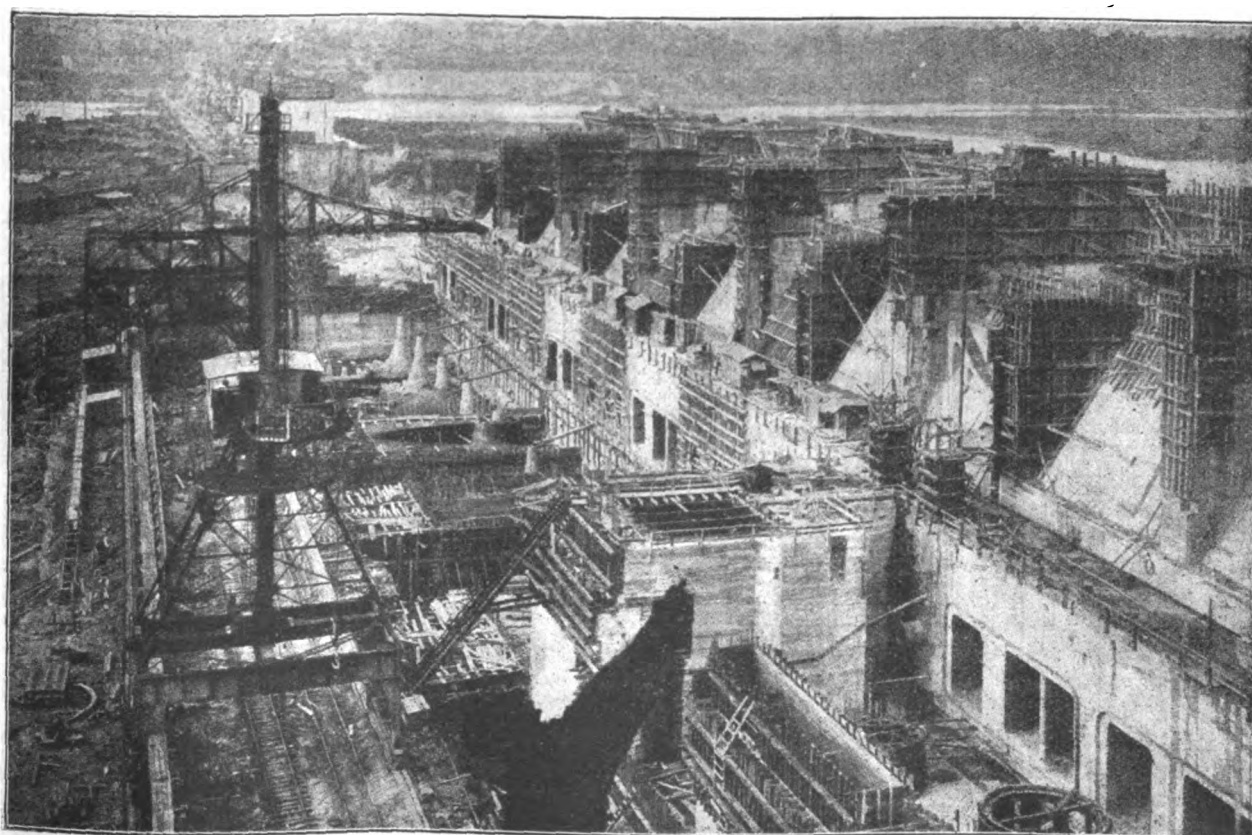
Autre vue photographique prise pendant la construction du barrage n° 2.
